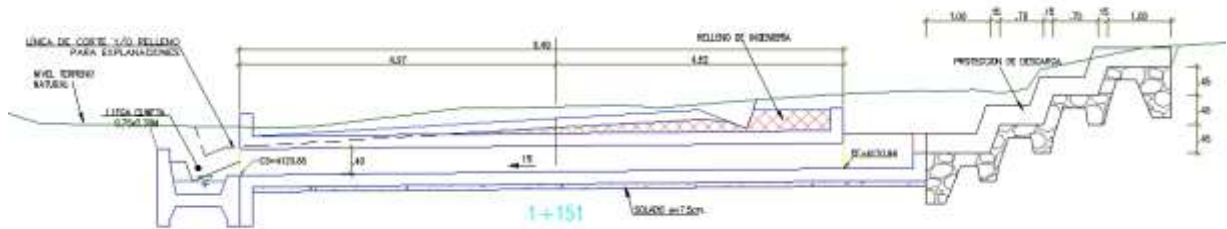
Alcantarilla Marco de concreto. Fuente: Planos de secciones de alcantarilla.
